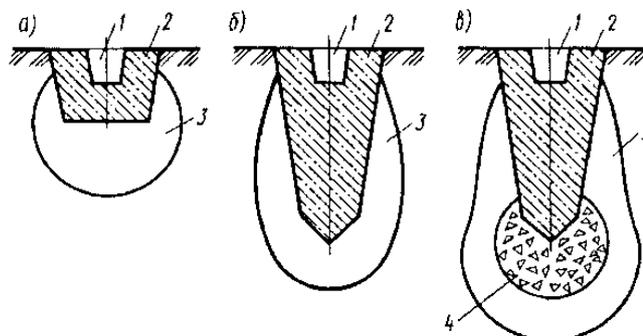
Схемы устройства методом вытрамбовывания котлованов фундаментов с плоской подошвой (а), с заостренной подошвой обычного типа (б) и с уширенным основанием (в): 1 – стакан для установки колонны; 2 – фундамент; 3 – зона уплотнения; 4 – втрамбованный жесткий грунтовый материал
